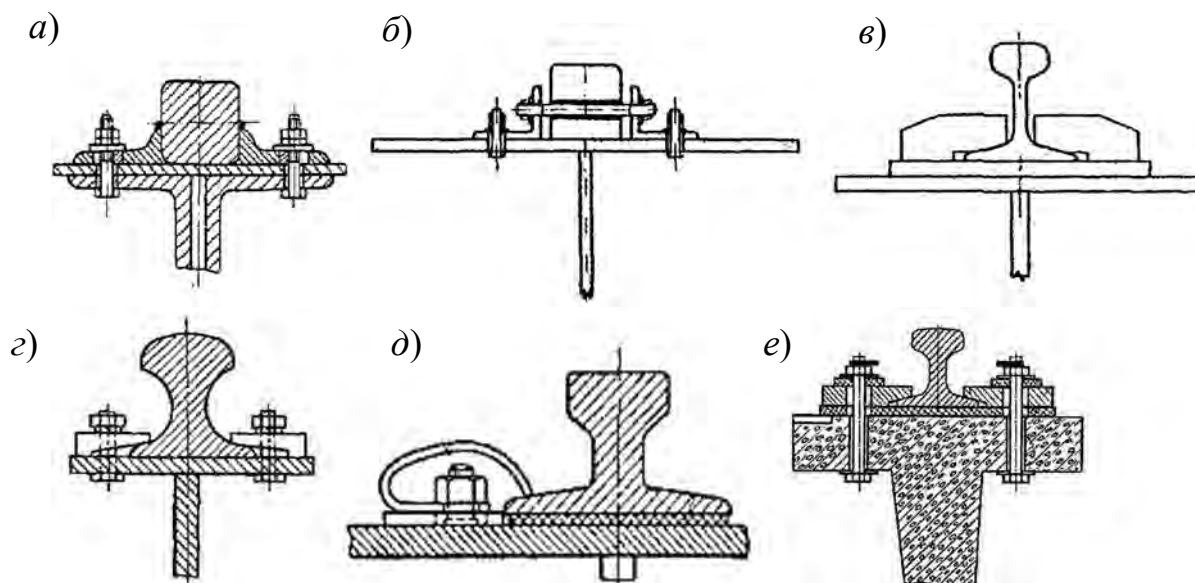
Крепление рельсов к металлическим подкрановым балкам: *а* – болтовое с приваренными уголками; *б* – болтовое с уголками; *в* – приваренными скобами; *г* – болтовое с накладками; *д* – пружинными скобами; *е* – болтовое к железобетонной подкрановой балке
